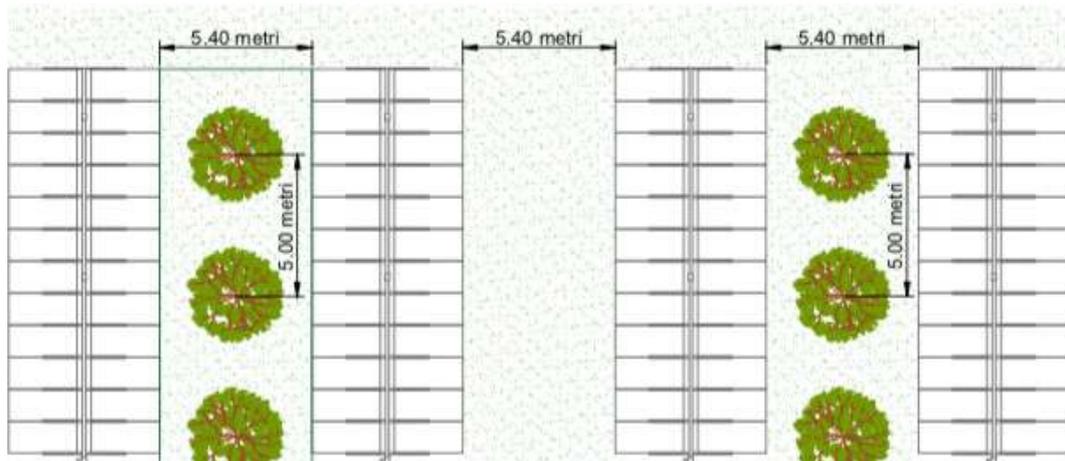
Vista in pianta della disposizione dell'oliveto a file alterne
